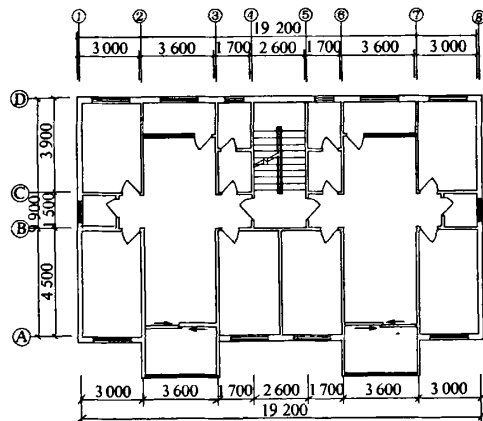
莱钢樱花园 4# 楼一个单元标准层平面图^[10]
